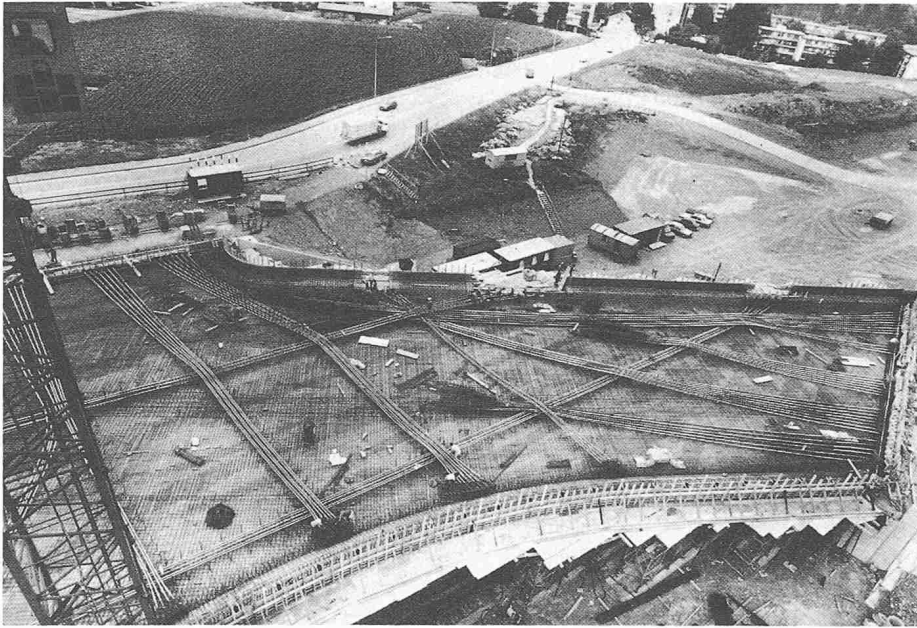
Vorspannarmierung und untere schlaaffe Bewehrung
